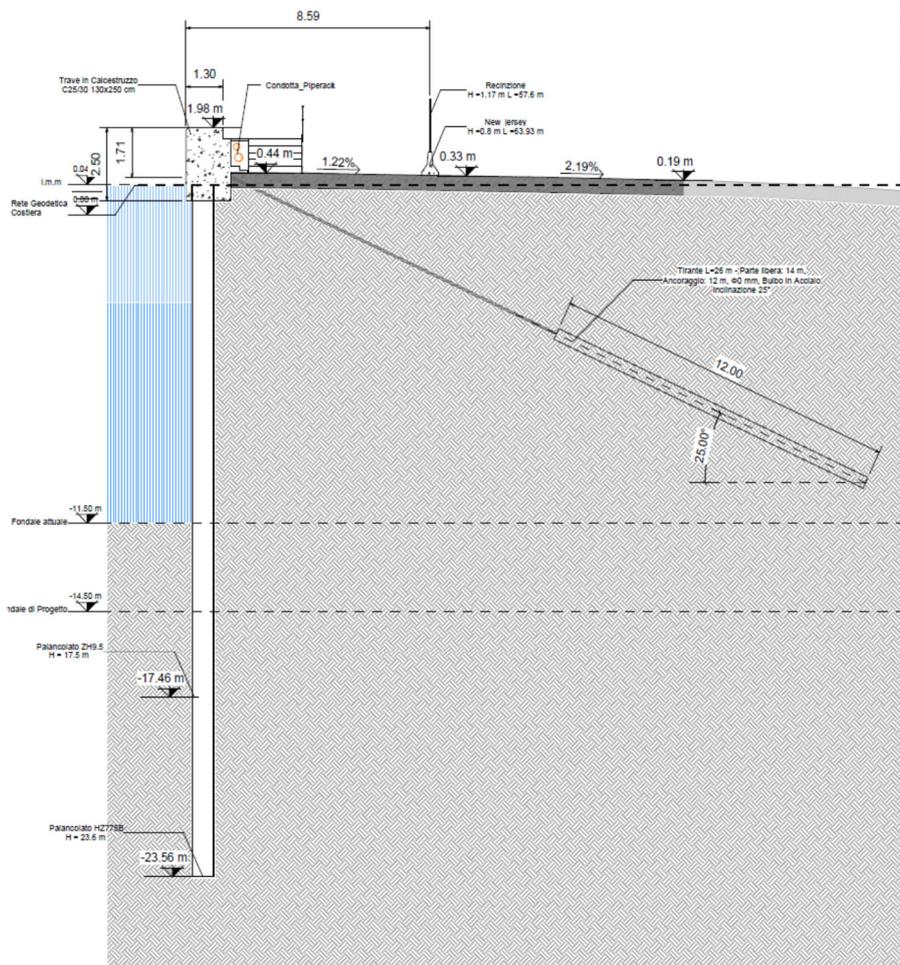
Sezione tipo della banchina Bunge Sud nella situazione attuale
